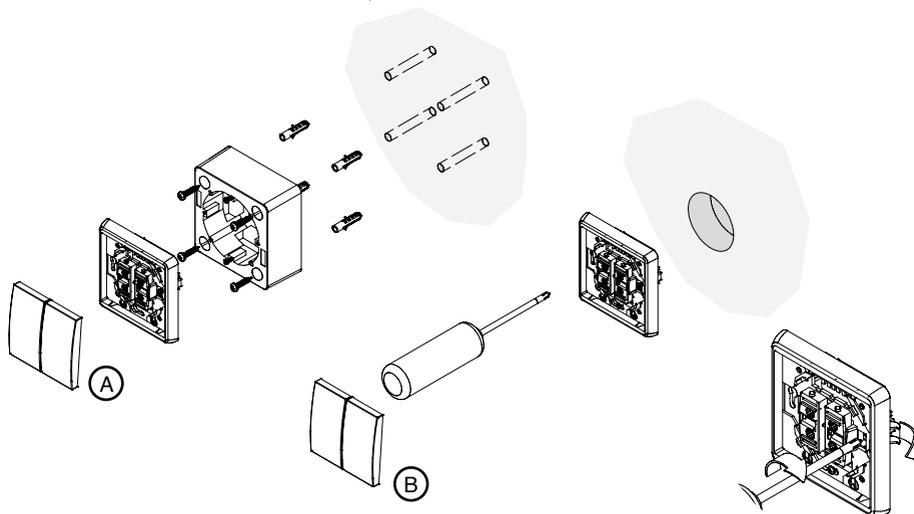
Entfernen Sie die Auf-/Ab-Tasten, ohne einen Schraubendreher zu verwenden.
